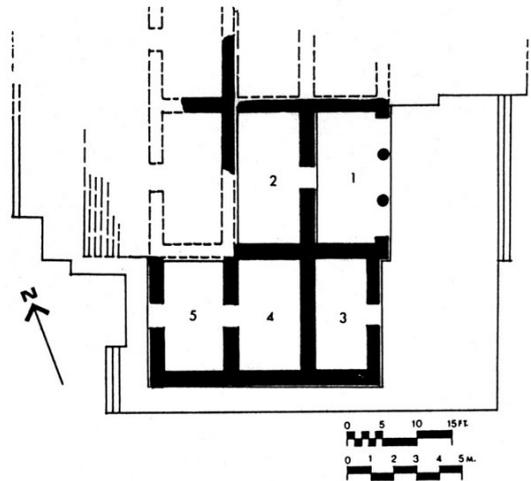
Tohcok, Campeche. Estructura 1. Planta. Tomado de Andrews, 1985.
